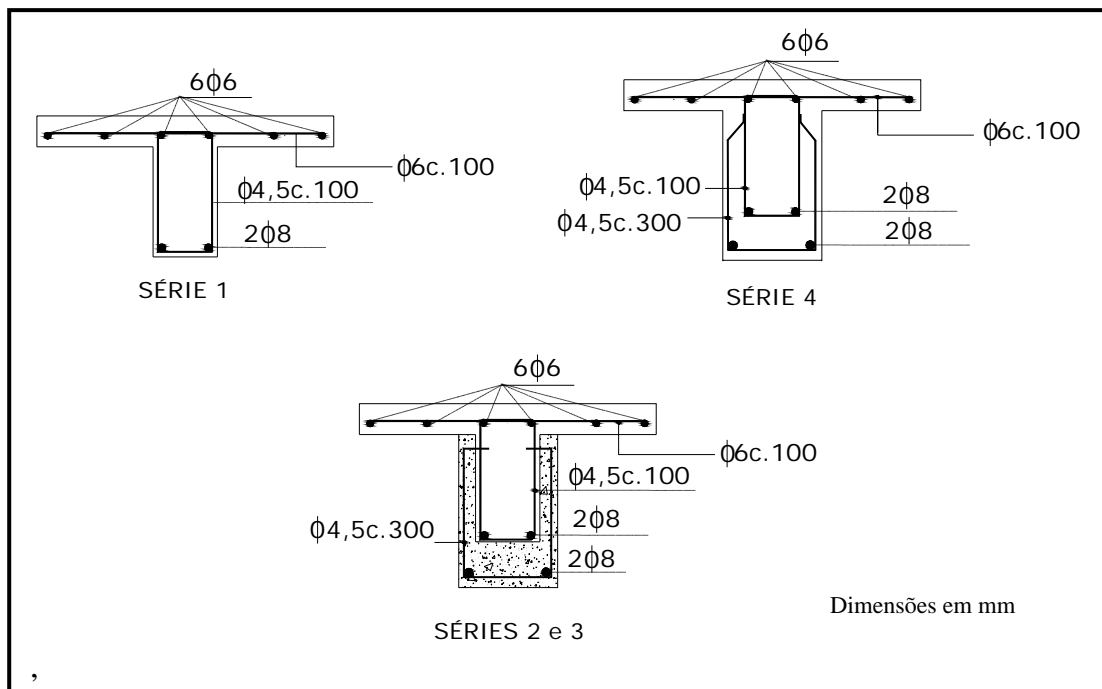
Armaduras das vigas ensaiadas por SOUZA (1990).
